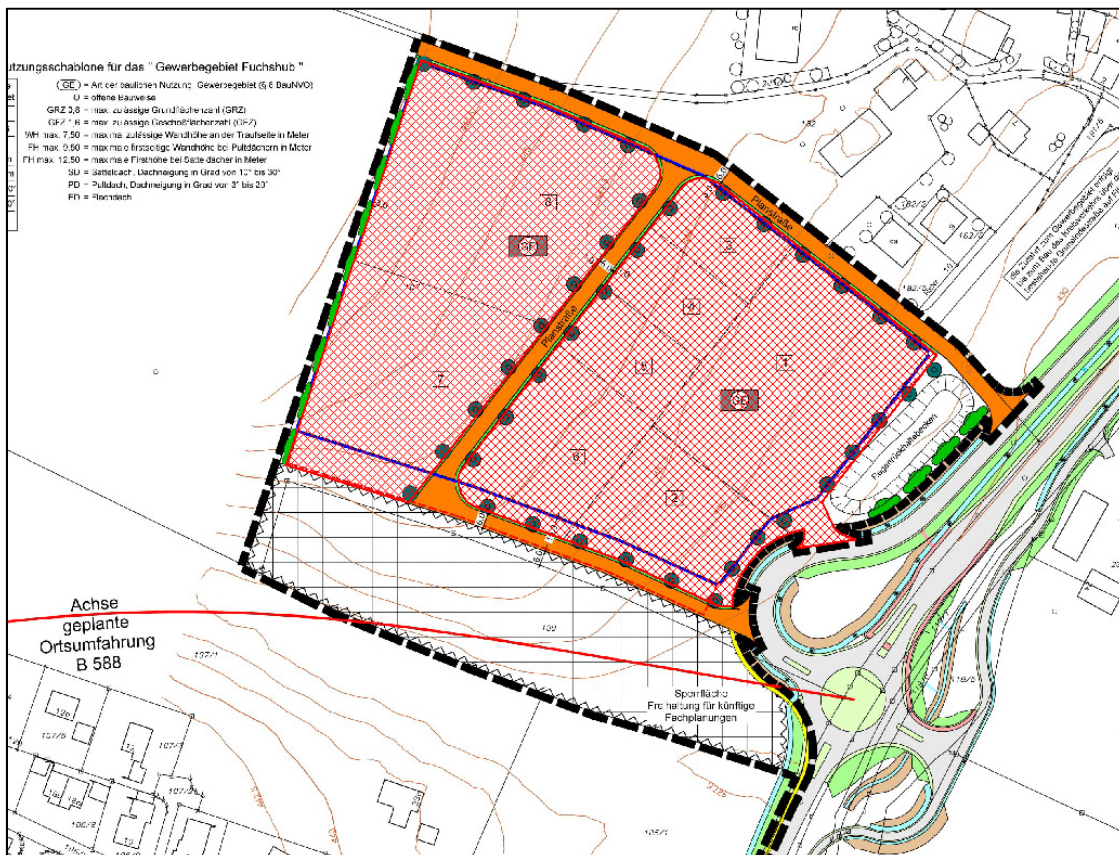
Lageplan mit Darstellung der gewählten Emissionsbezugsflächen  $S_{EK}$
